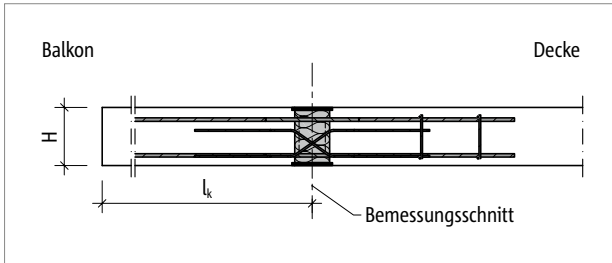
Schöck Isokorb® XT Typ DP: Statisches System
